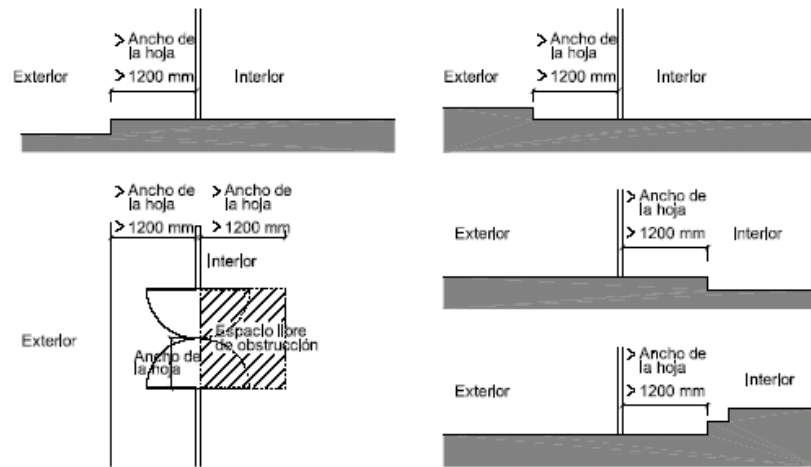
Distancia entre la puerta de acceso y el escalón más próximo
